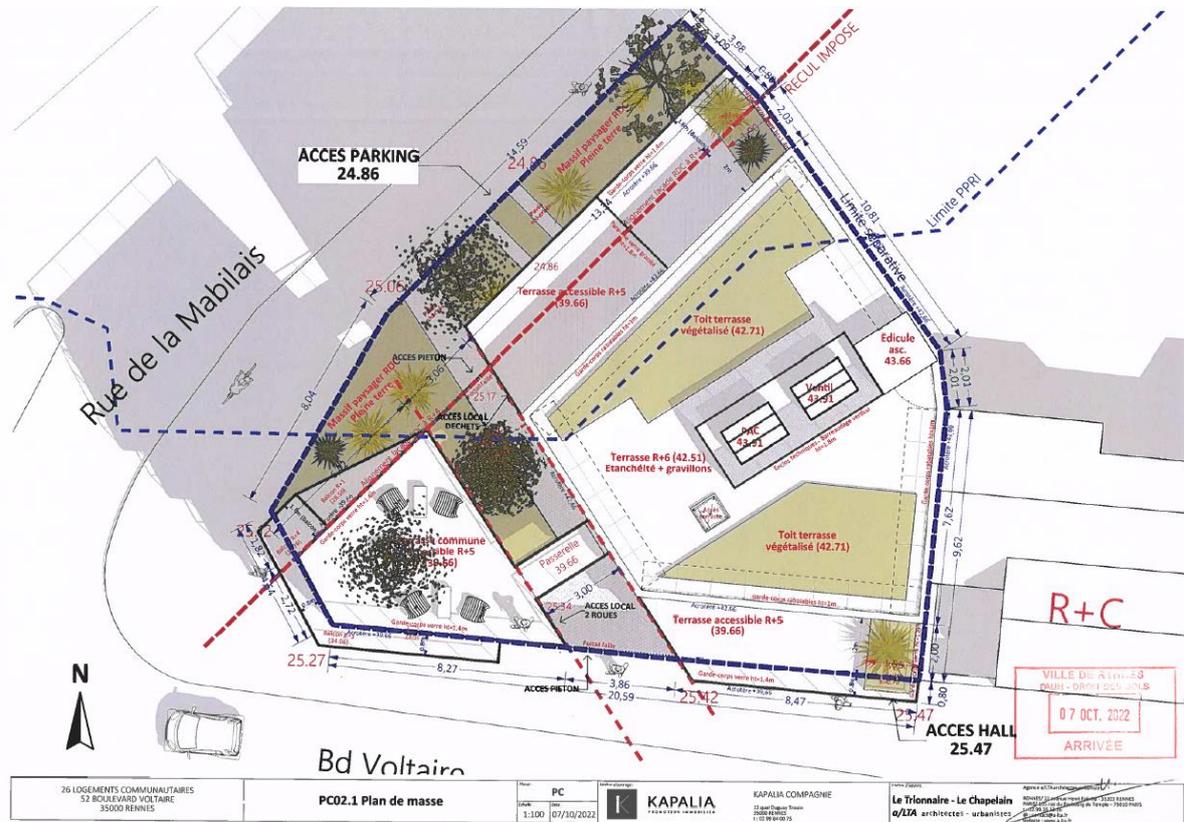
Plan de masse au 07/10/2022 - © ALTA Architecture
